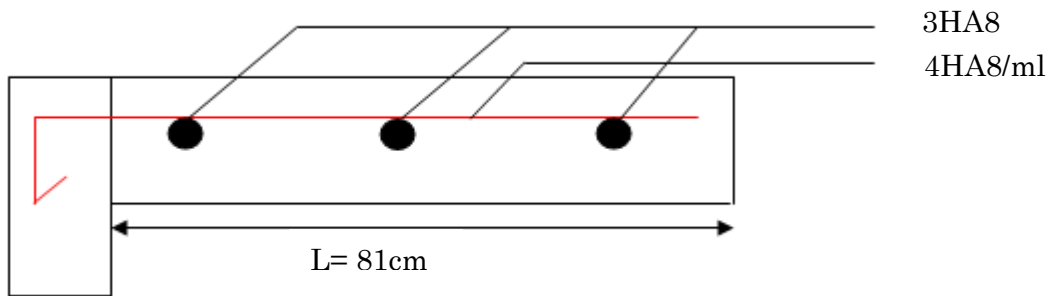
Schéma de ferrailage de la dalle sur 1 appui (Balcon)
